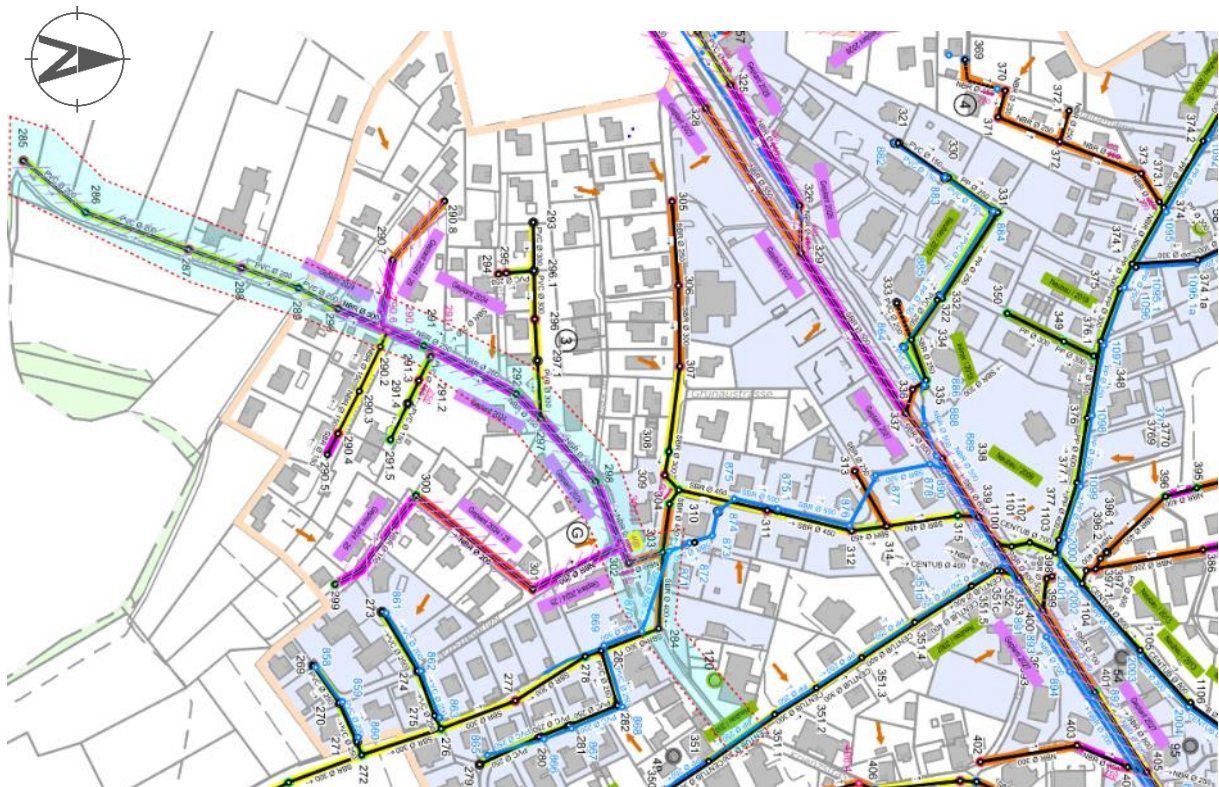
Ausschnitt aus dem GEP-Betriebsplan Jg. 2014 (Quelle: Flury Planer + Ingenieure AG)
